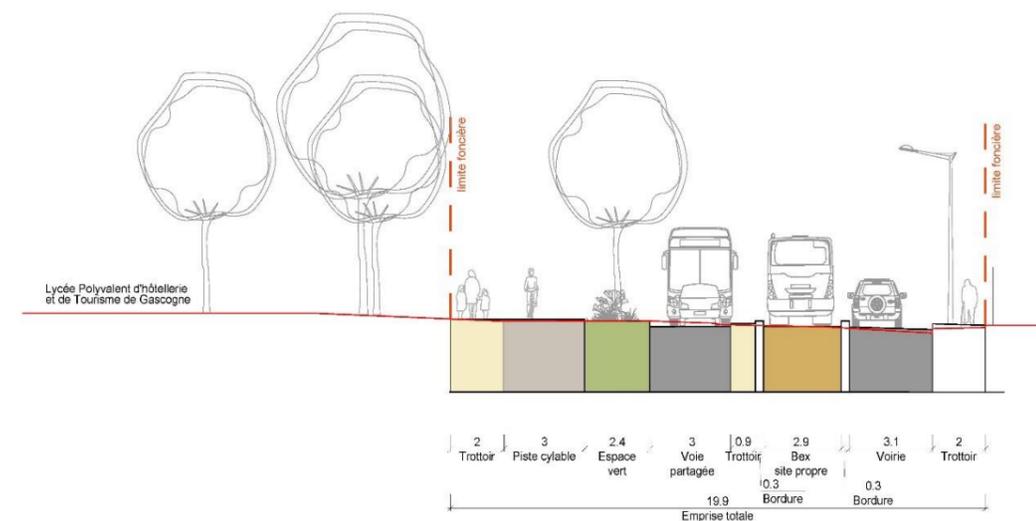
Coupe type sur l'avenue de Thouars Nord
